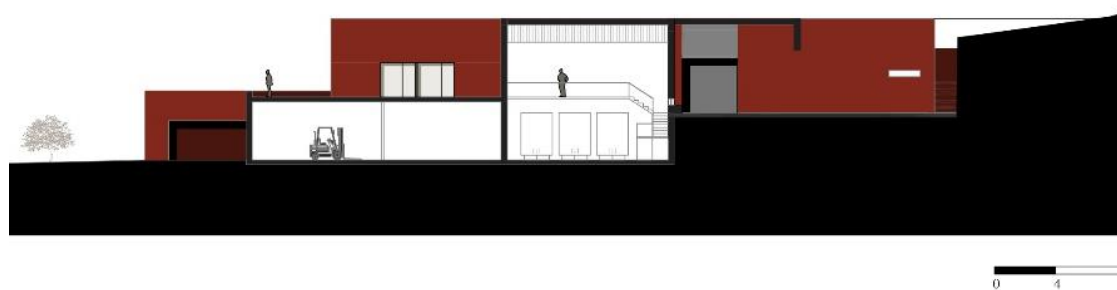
Corte Longitudinal (Desenho à escala 1:200 em anexo)
